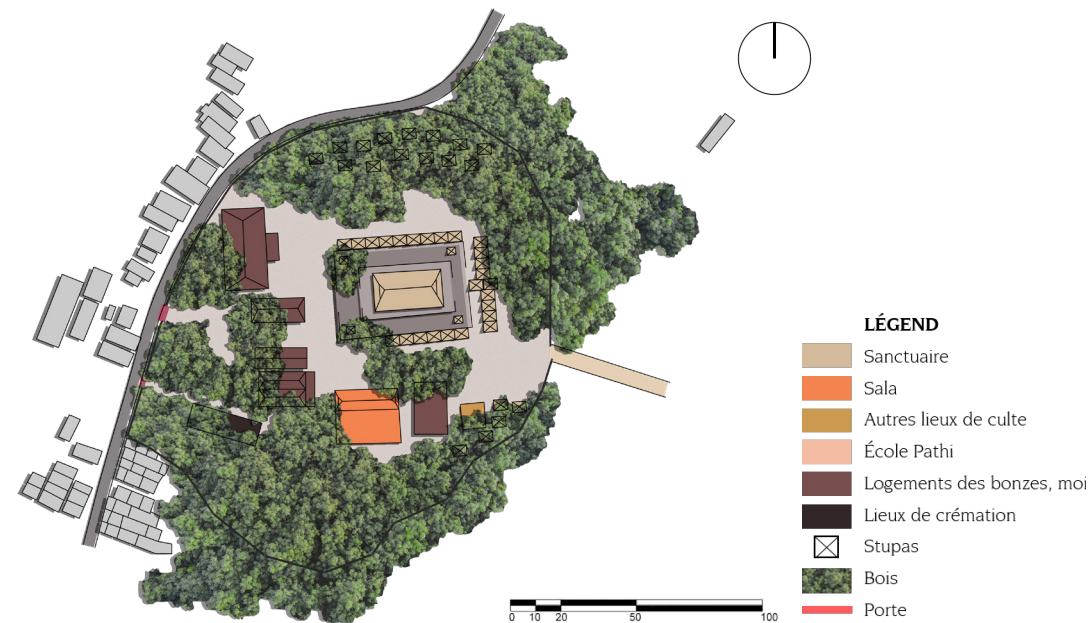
Plan guide de Wat Pôthisatharam (2,3 ha) - Plan guide traditionnel du Wat
